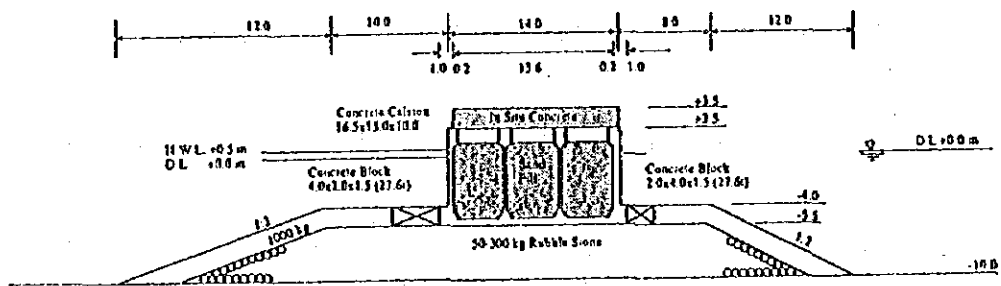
防波堤標準断面図—ケーソン堤 (-10.0m)
